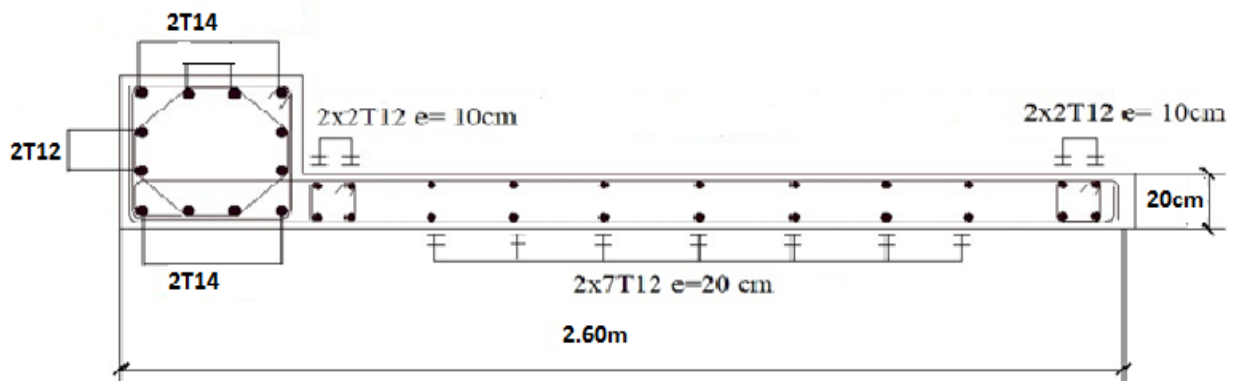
Schéma de ferrailage du voile en (S4) sous forme L.
